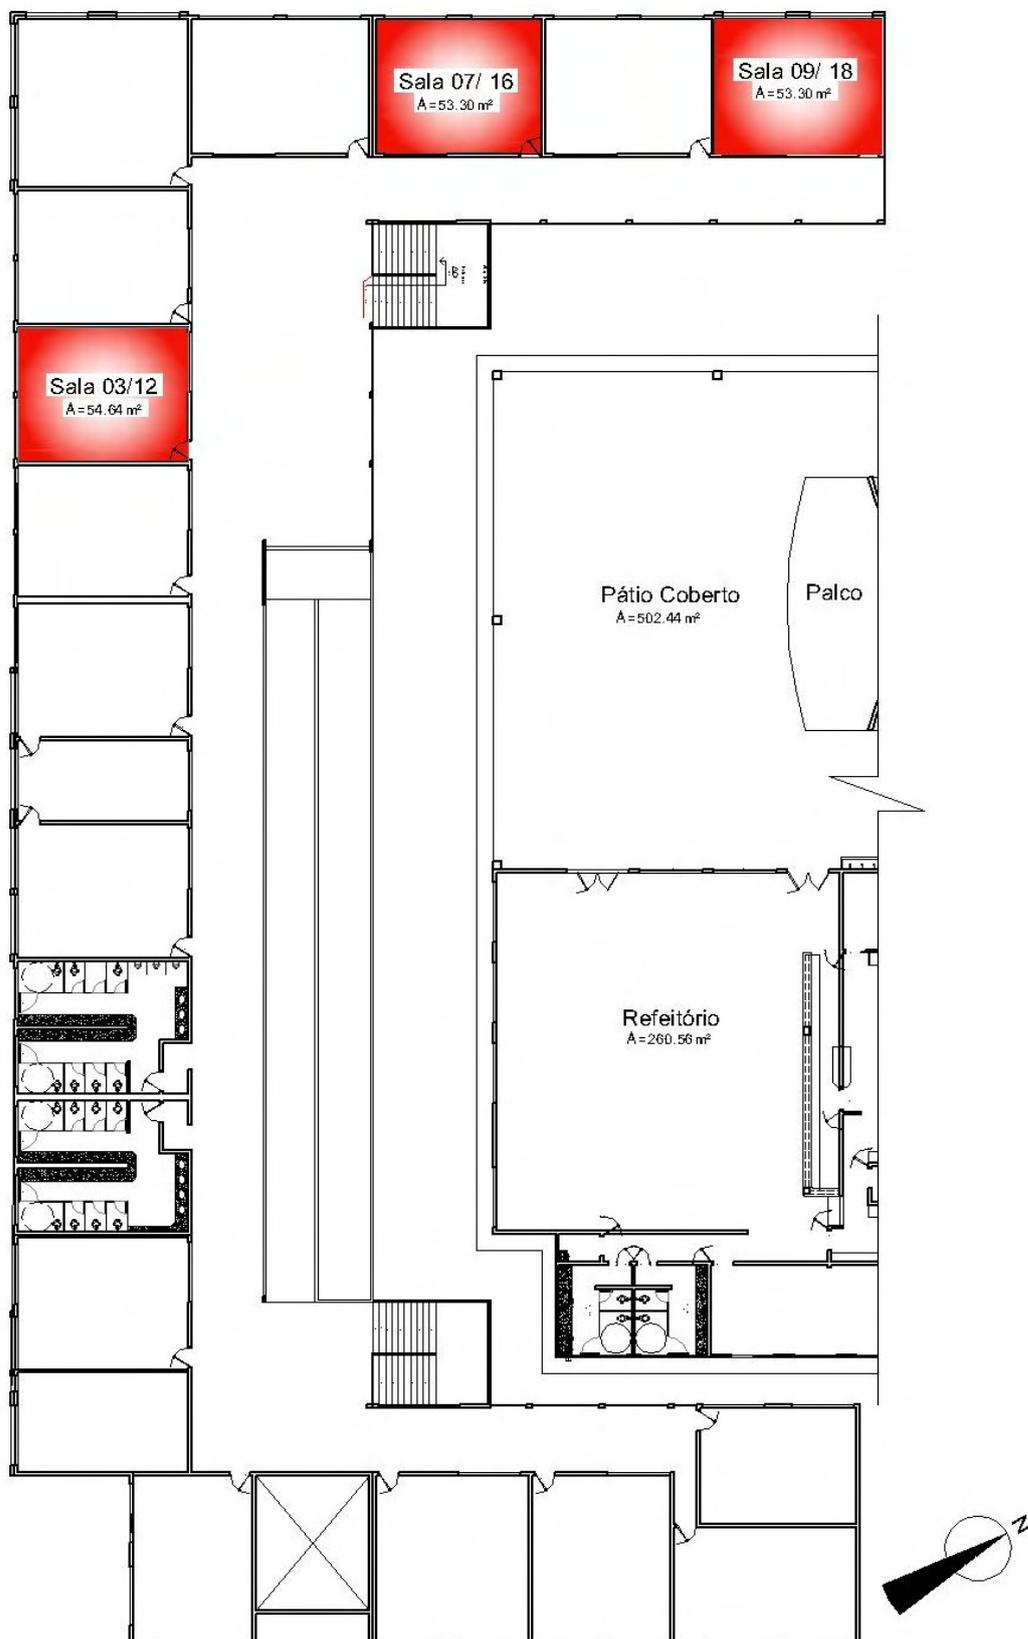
Planta Baixa Térreo e 1ª Pavimento Bloco Salas de Aula
